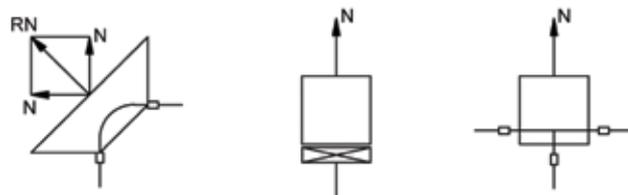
Schematische Darstellung der Schubkräfte in Rohrleitungen
